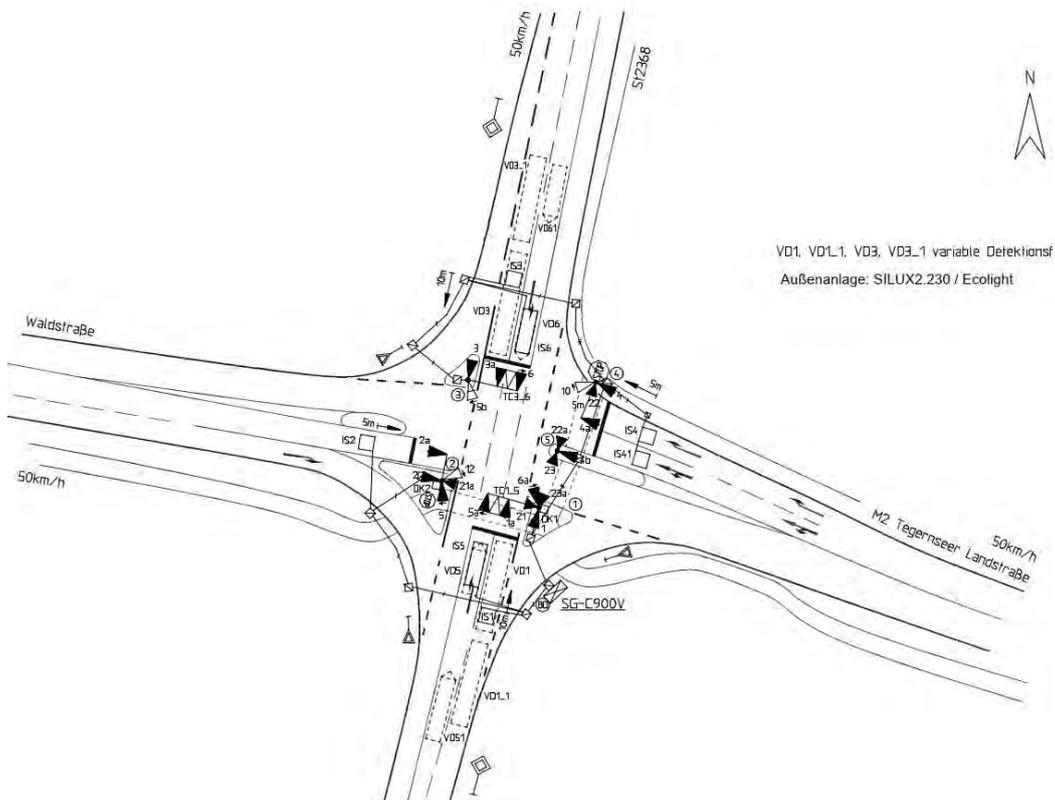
Ausschnitt Lageplan Lichtsignalanlage St2368/ M2/ Waldstraße (Quelle: staatliches Bauamt Freising, Siemens Mobility GmbH, 2012/2021)
